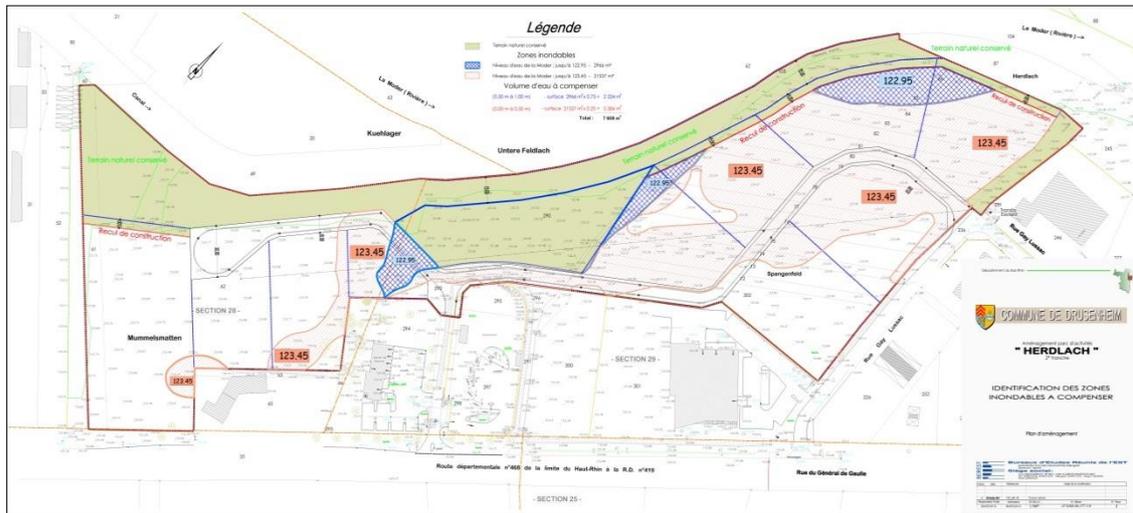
Zone d'activités Herdlach 2 – extrait de plan masse (source : étude BEREST)
